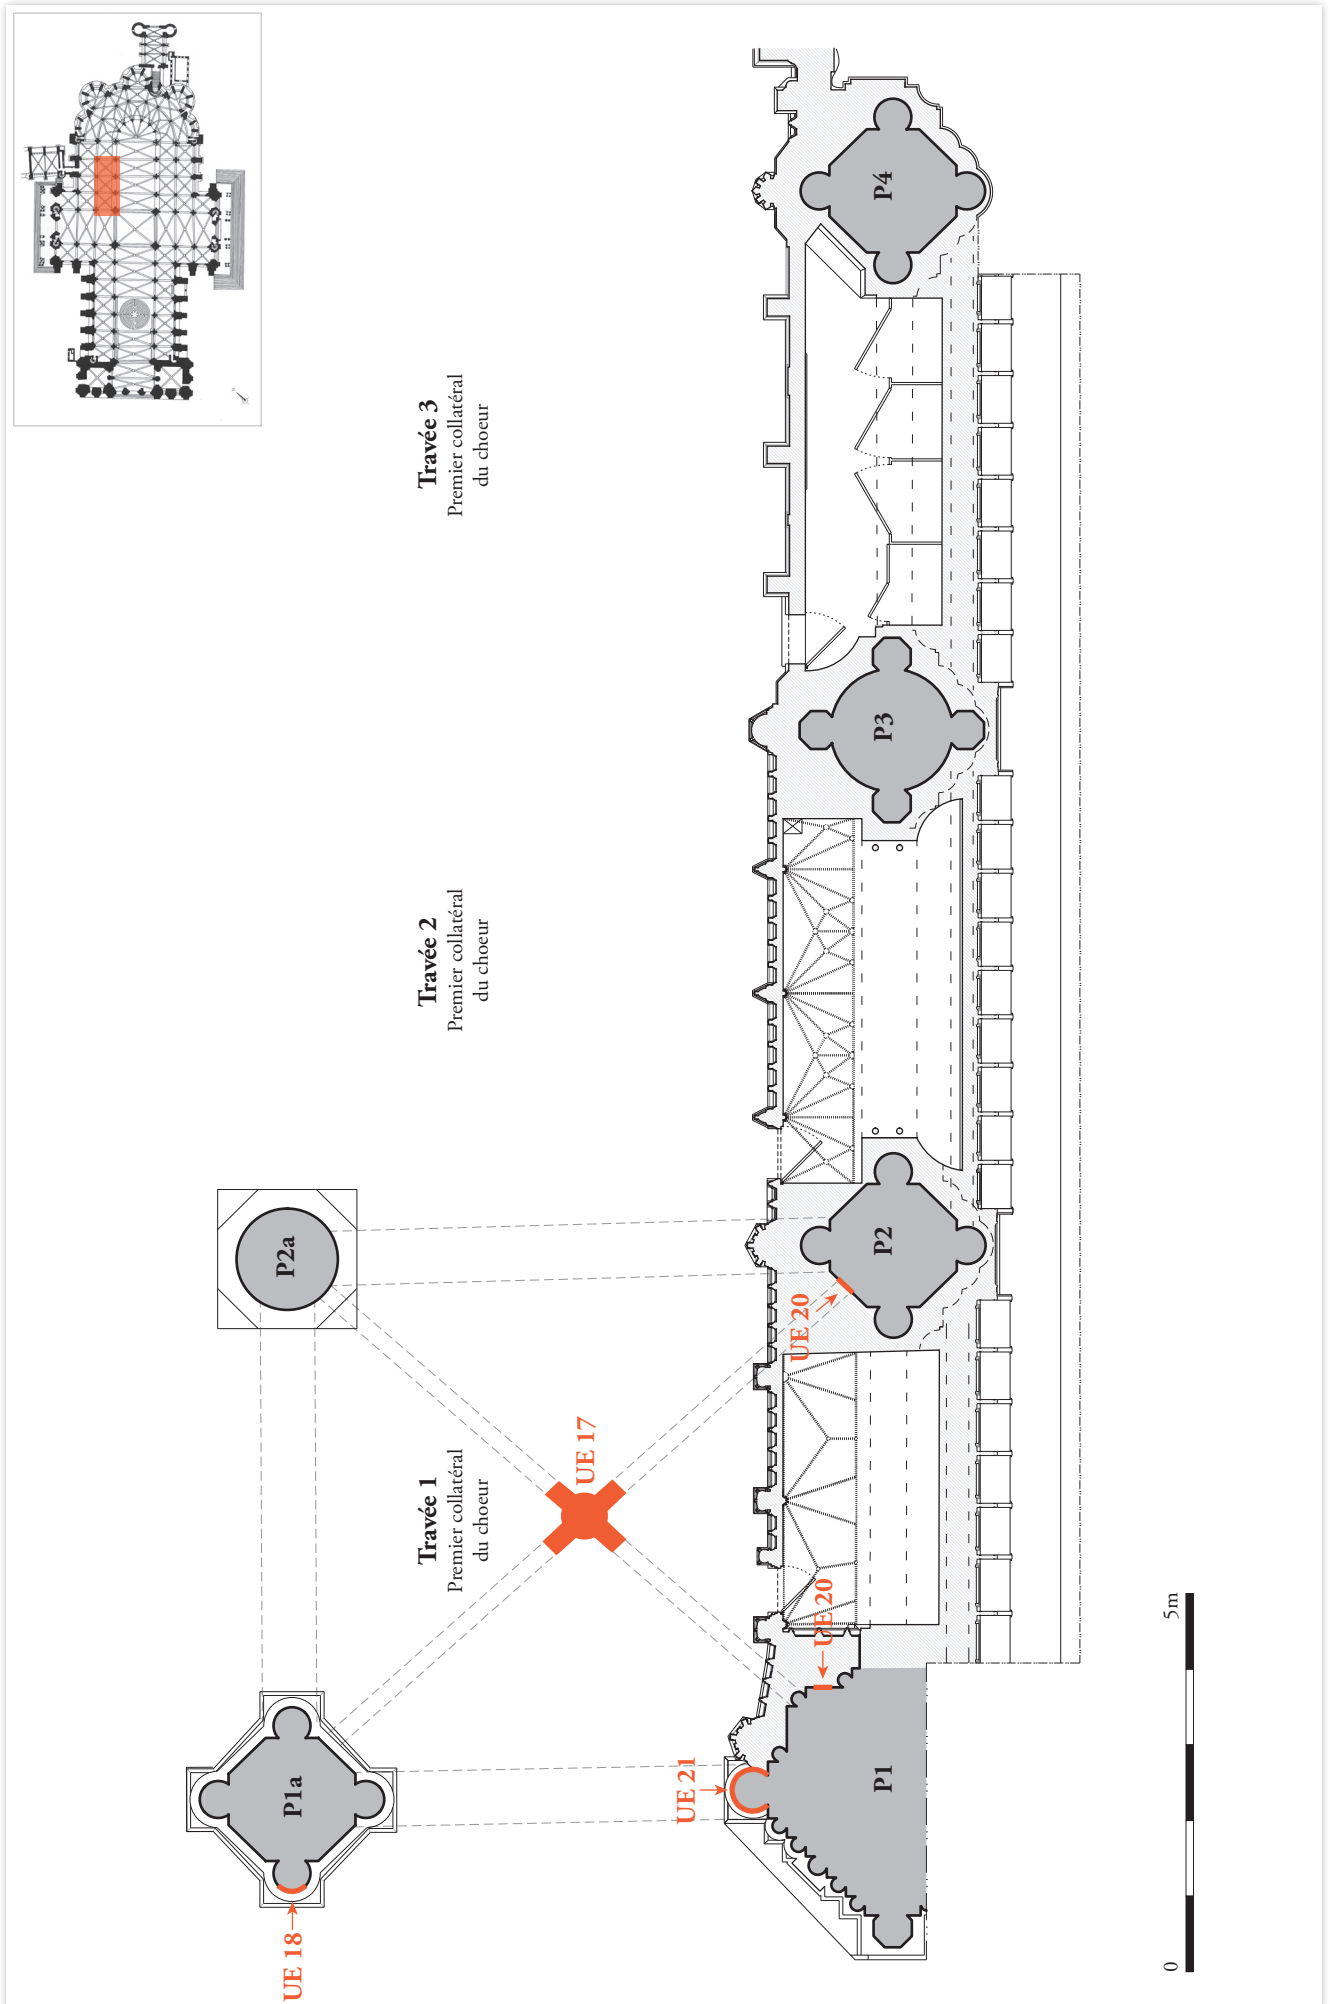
• Plan de la travée 1 du premier collatéral NORD du choeur et des piliers P 3 et P 4, localisation des décors polychromes – échelle : 1/100.
